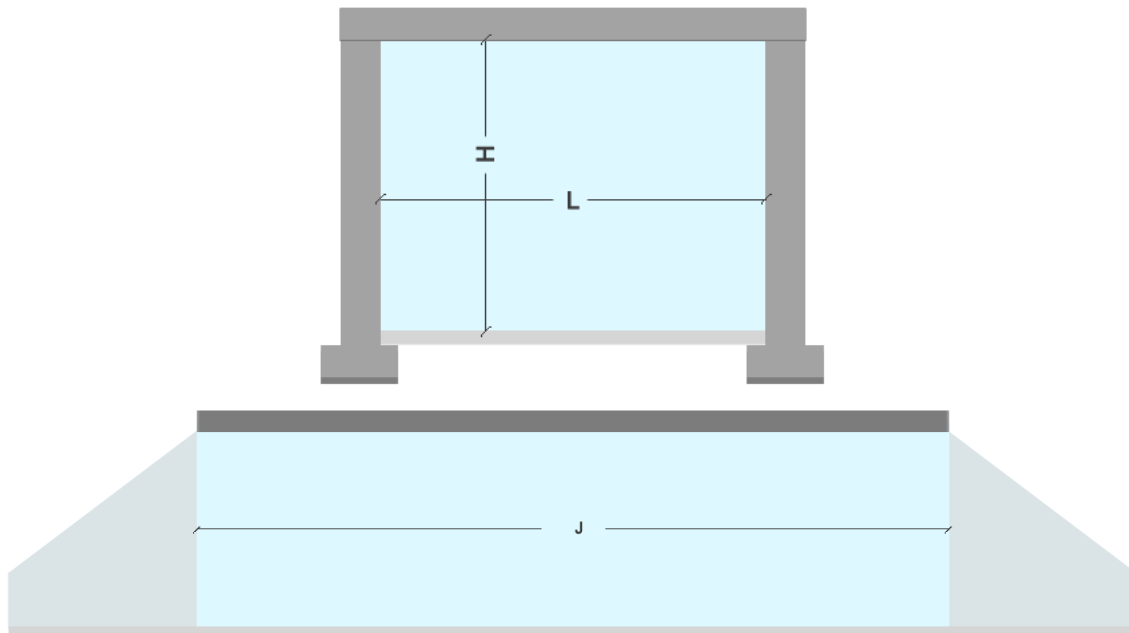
Esquemas de cortes transversal (arriba) y longitudinal (abajo) de alcantarilla.
